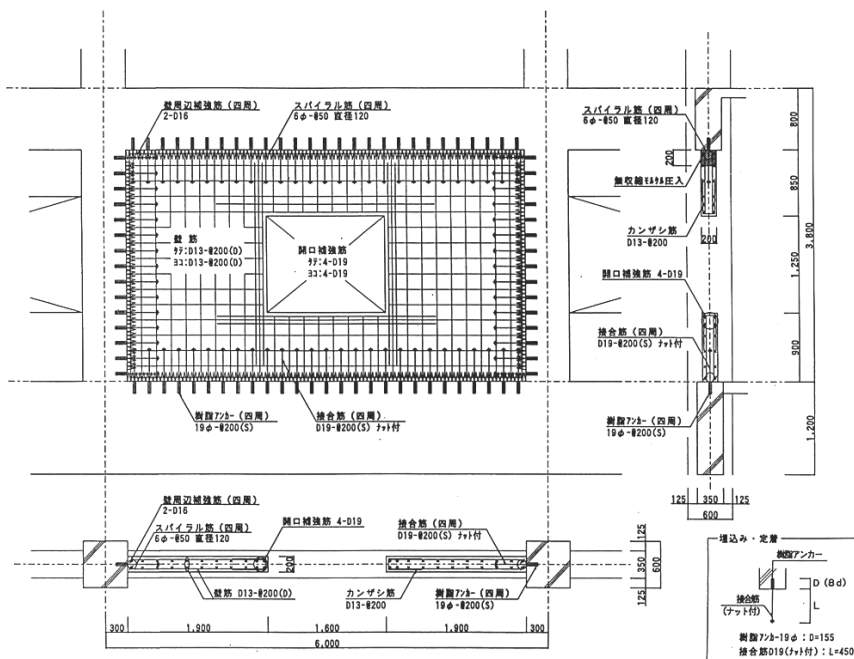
RC造耐震壁の増設による耐震補強<sup>3-1)</sup>
